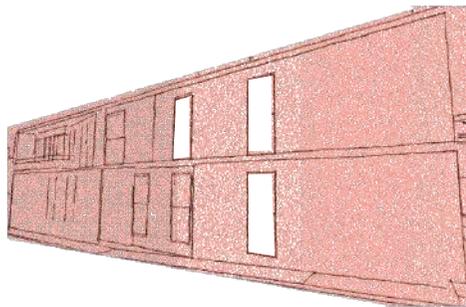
Uso de concreto aparente rojizo. Boceto. Fuente: Propia
